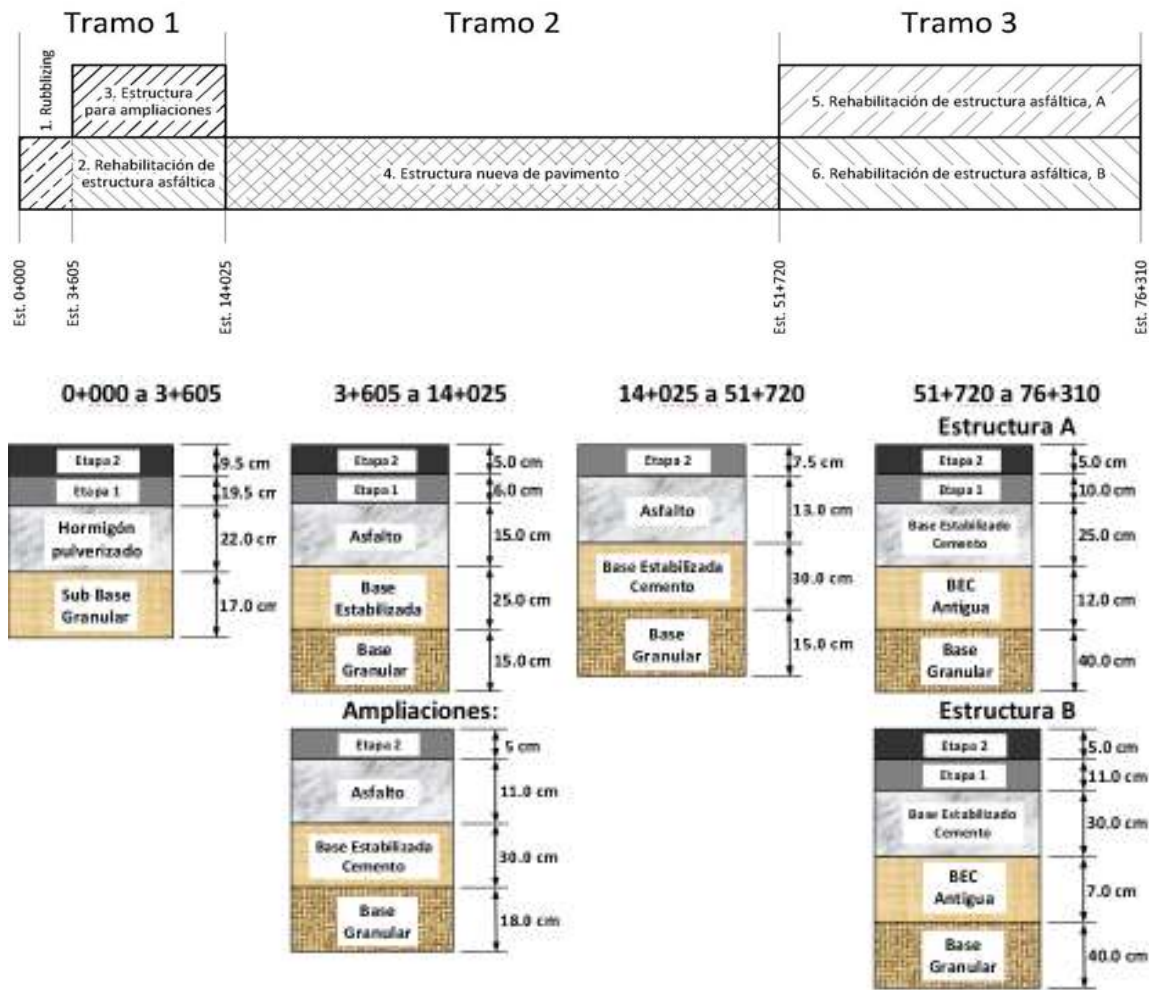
Paquetes estructurales construidos en el proyecto San José - Caldera
